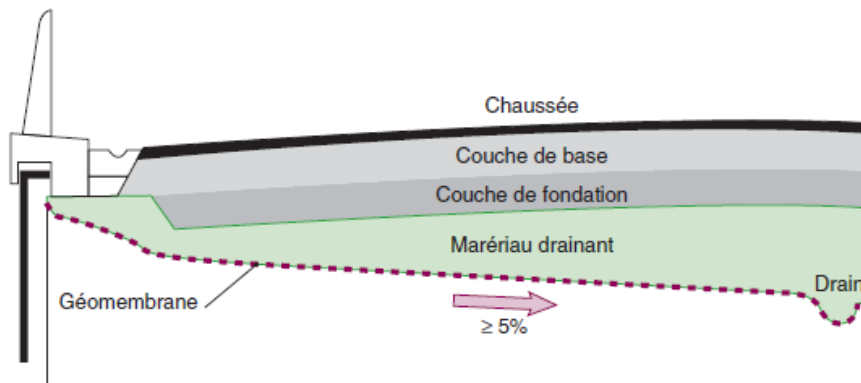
Exemple d'une protection contre les eaux de ruissellement (LCPC, 2003).
